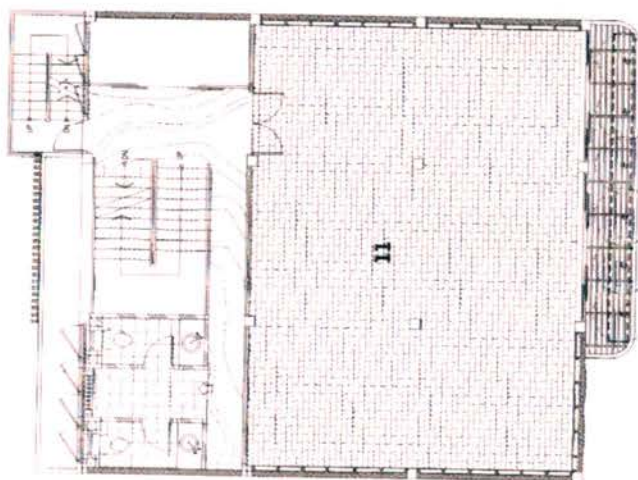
แสดงส่วน 2nd Floor Plan
